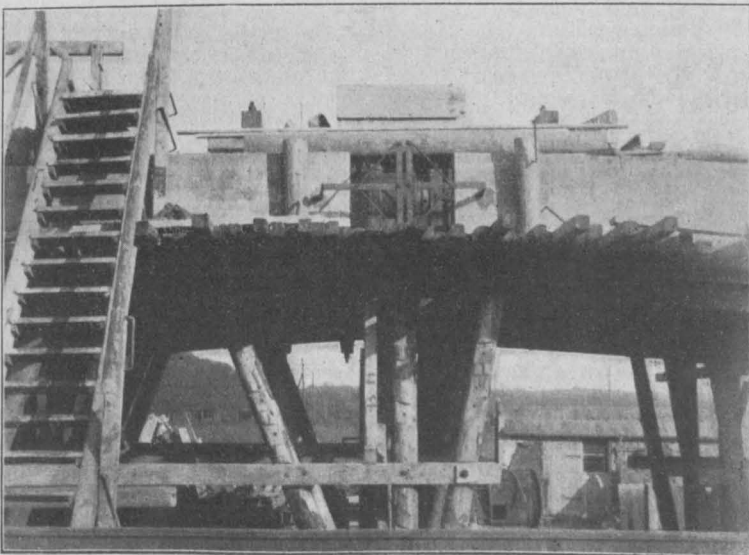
Ansicht der Pressen nach dem Ausrüsten. An den Flacheisen erkennt man die entstandene Expansionslücke.
